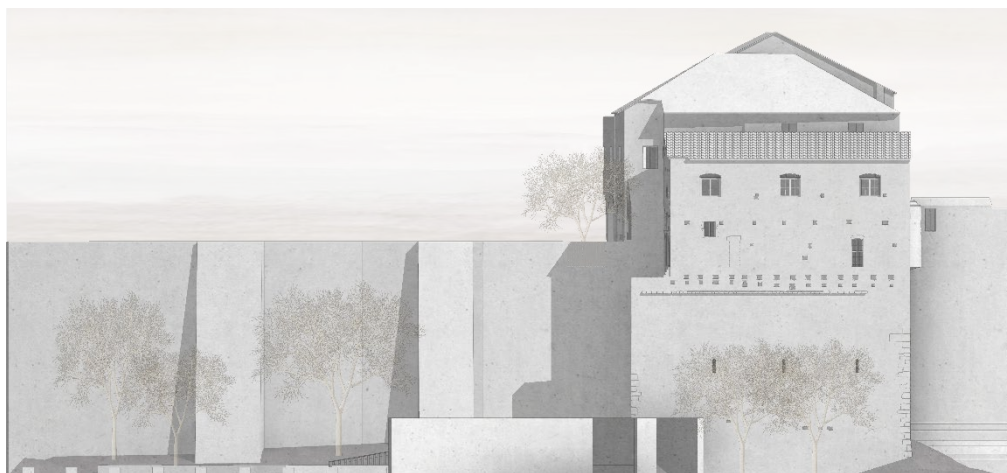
San Benedetto e le mura, prospetto longitudinale (elaborazione degli autori, 2024).
